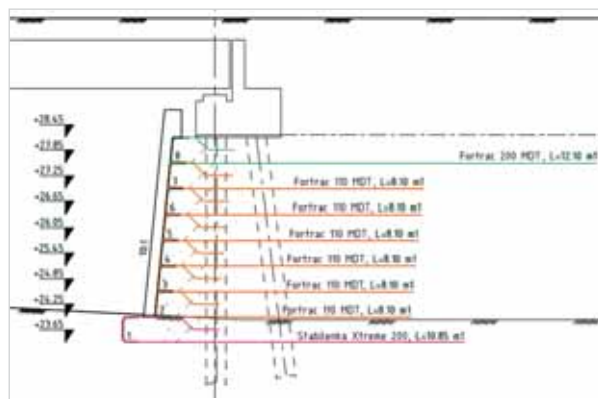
Конструкция опоры на свайном фундаменте в теле армогрунта подходной насыпи с армированием георешеткой Fortrac
